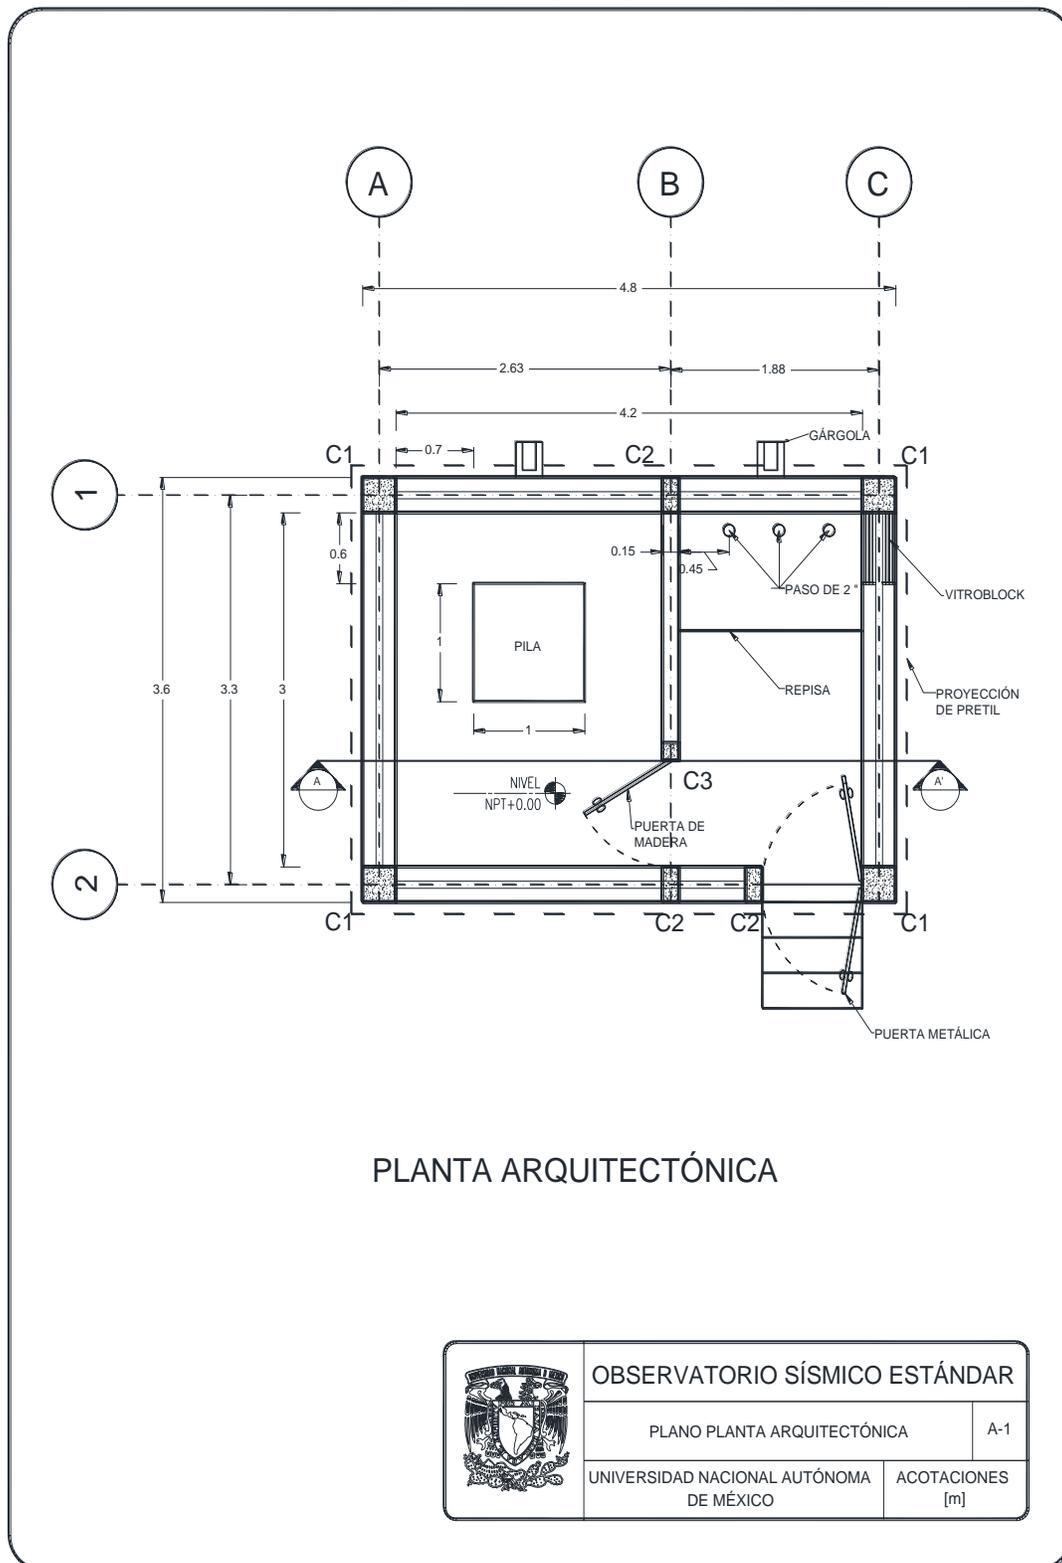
Planta arquitectónica, colocación de muros dobles
